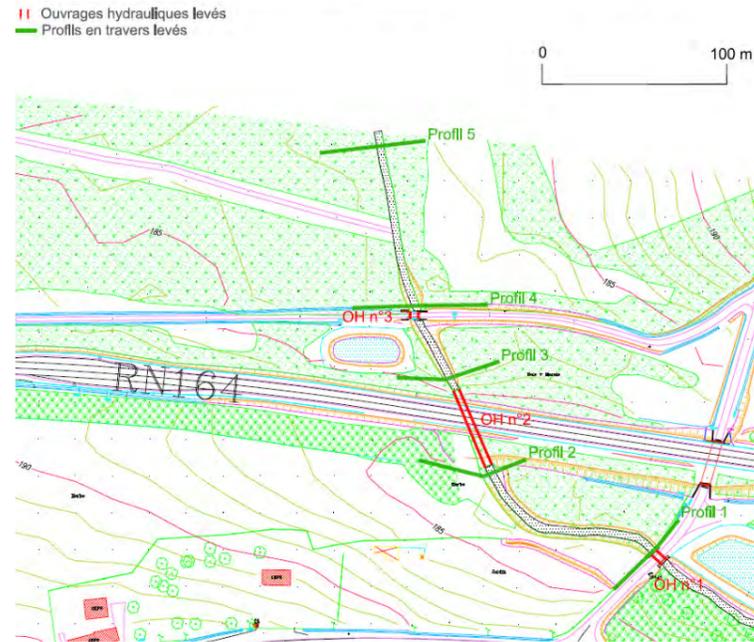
Localisation des levées topographiques et des ouvrages hydrauliques
